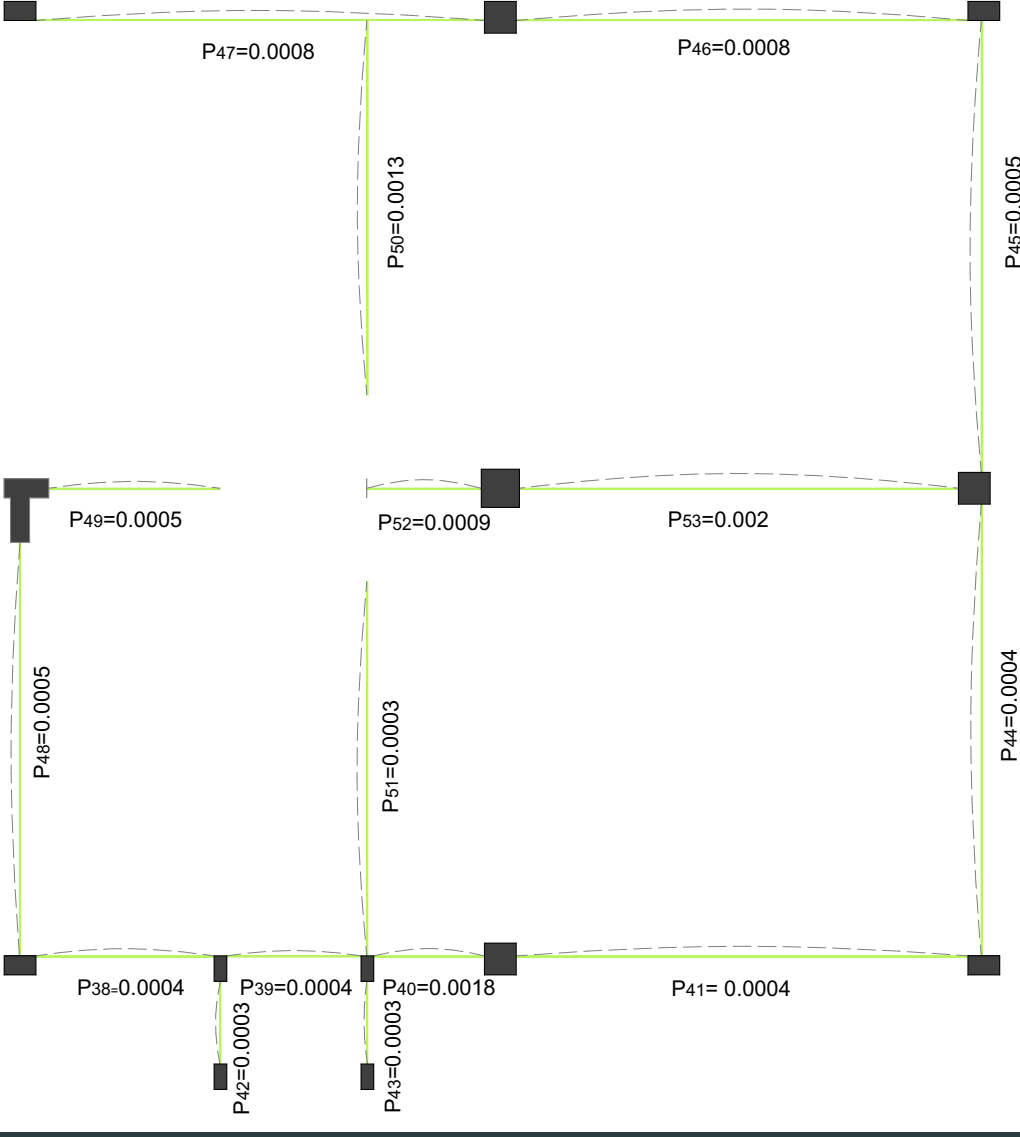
Esquema del lugar en planta de la deformación en paredes _ Primera Planta Alta _ N= +3.60.
